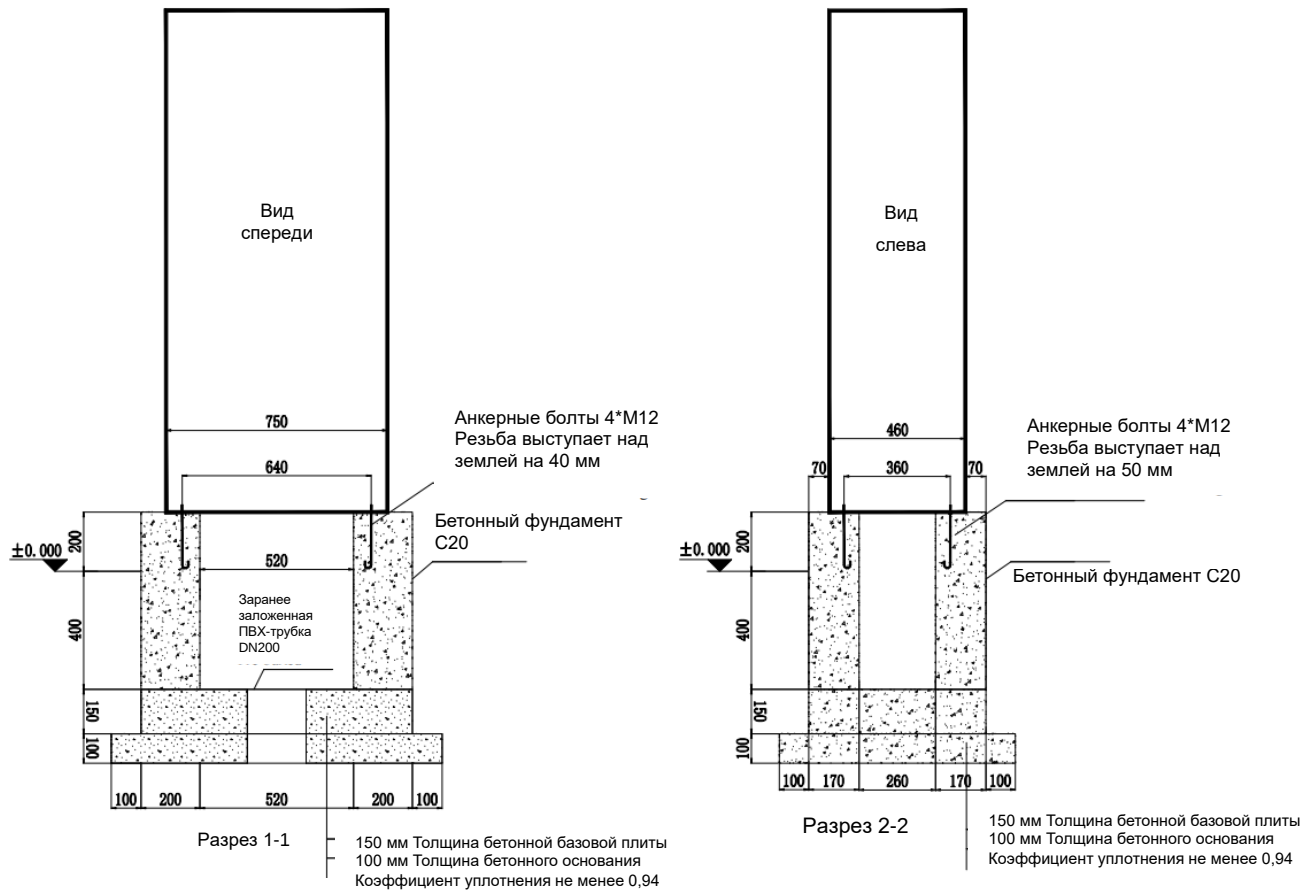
Схема фундамента YLNXD(50/60/80)K
